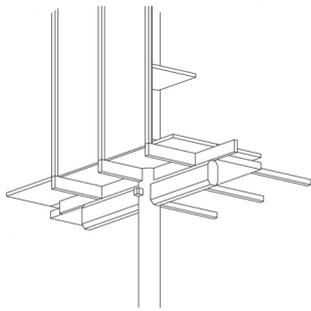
| Sistema constructivo de la galería y respectivo esquema
